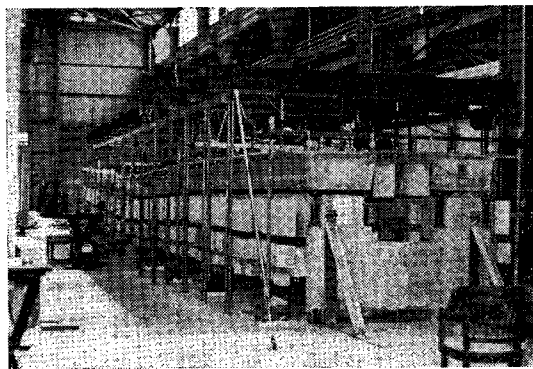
プレキャスト プレストレスト コンクリート 箱桁模型橋の破壊試験
